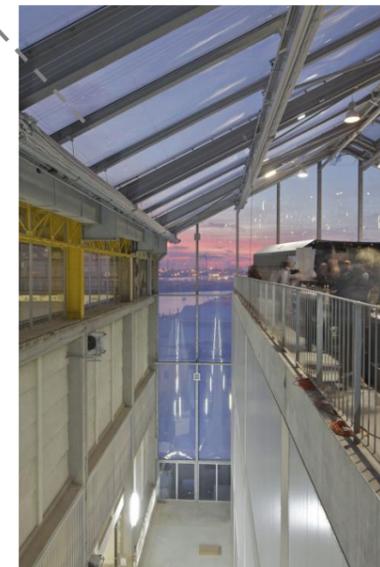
Estructura de cubierta del edificio FRAC. Fuente: Plataforma Arquitectura
